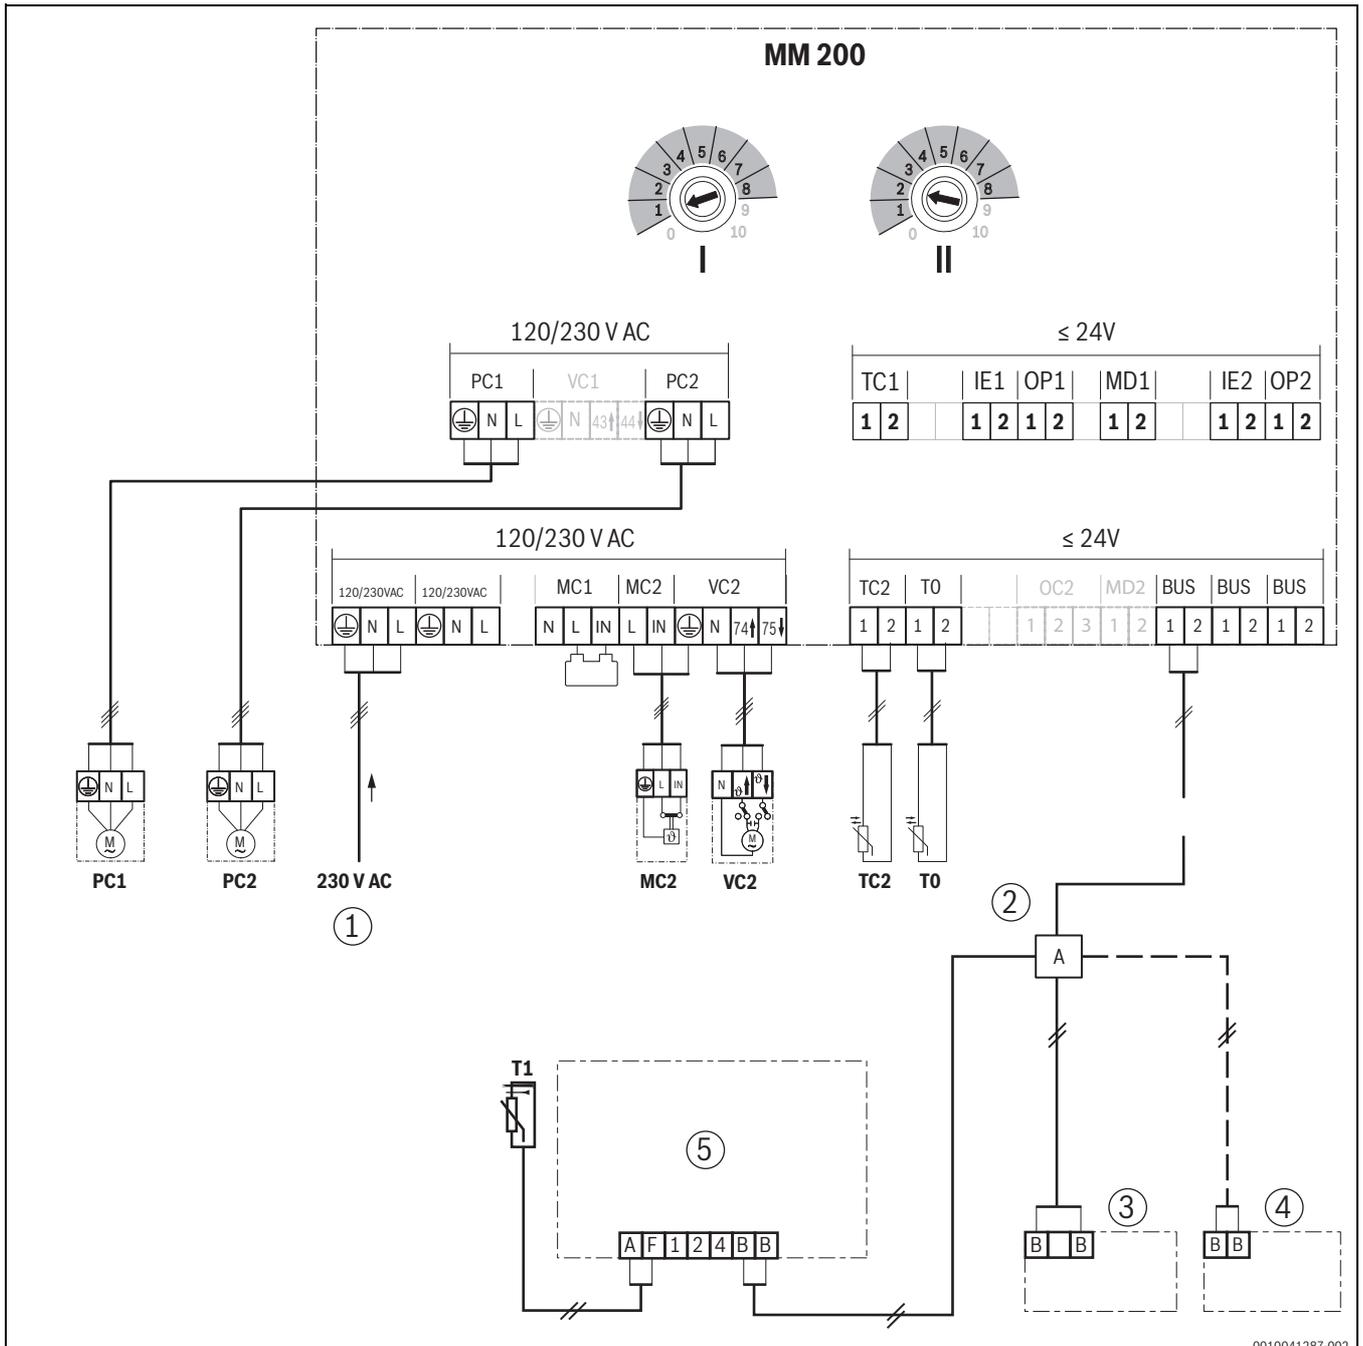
Schema elettrico di collegamento HSM2-U 20/7 MM200
